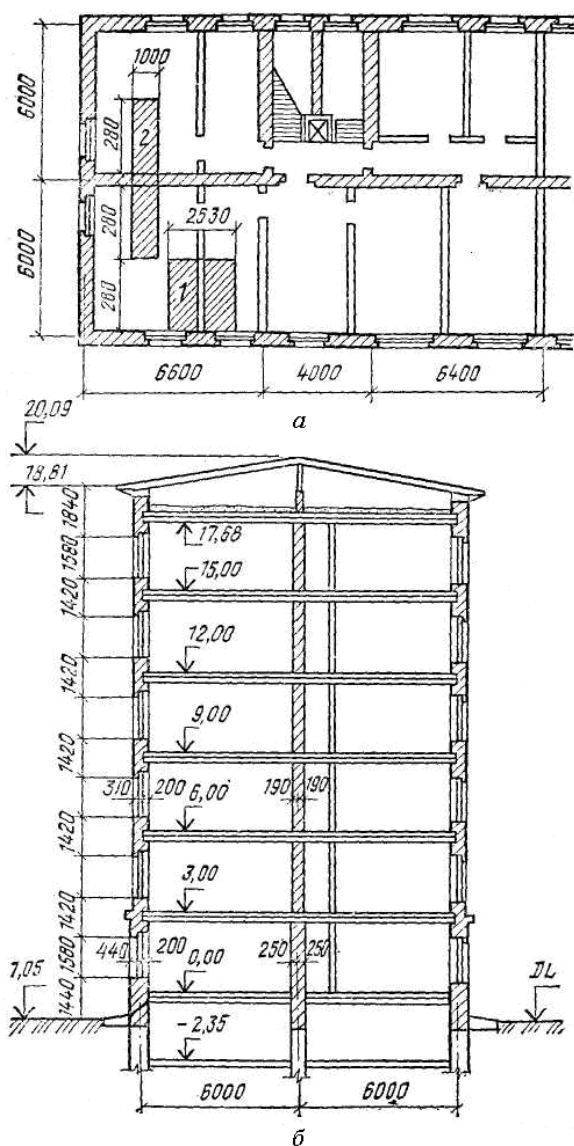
К сбору нагрузок на фундаменты: *а* – план; 1, 2 – грузовые площади соответственно для наружной и внутренней стен, *б* – разрез здания
